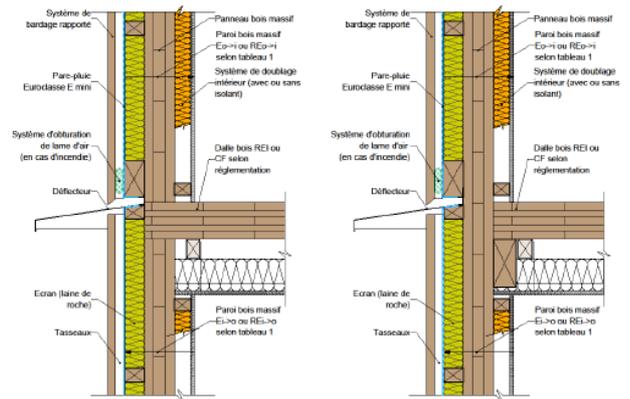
Exemples de solutions bardages D et C avec façade mur et plancher en CLT
